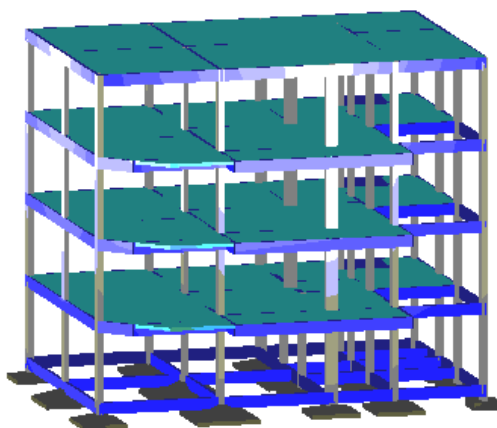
Exemplo de pórtico 3D (AltoQI Eberick)
